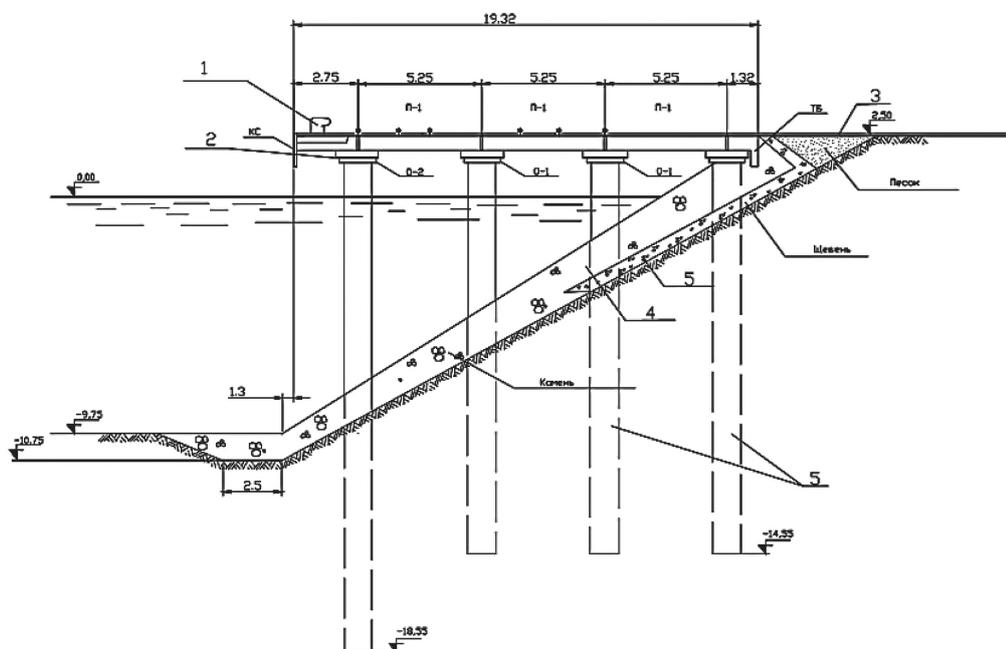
Железобетонная эстакада на предварительно напряженных сваях со сборным верхним строением с опорными капителями, 1-швартовная тумба; 2-наголовники; 3-покрытие; 4-подпричальный откос; 5 – фильтр; 6 – сваи.
